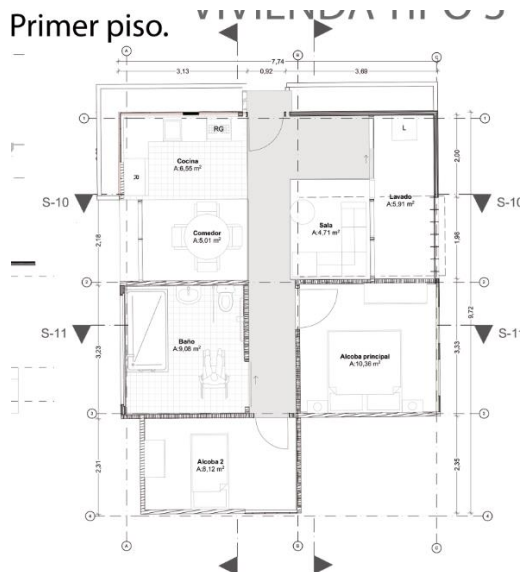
Planta Primer Nivel vivienda 3. Autoría propia.
